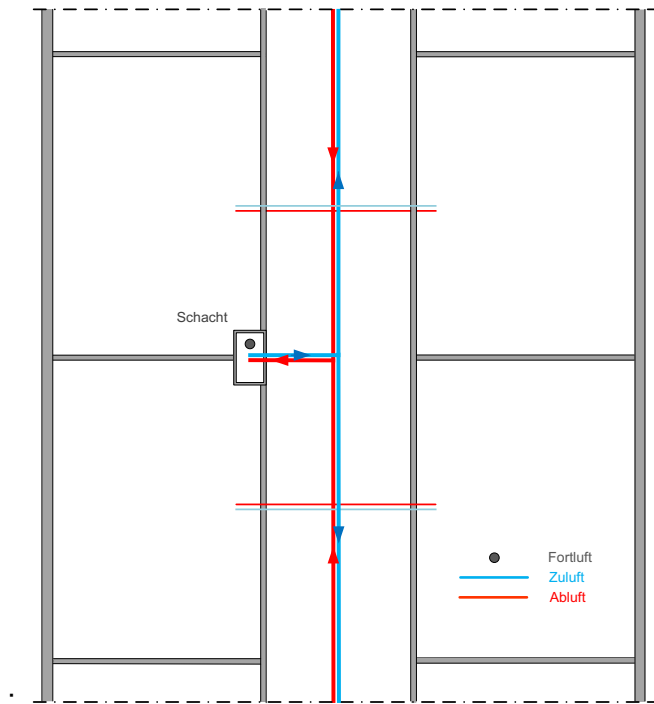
Grundschema der horizontalen Versorgung - Lüftungsanlagen⁴⁹⁴
